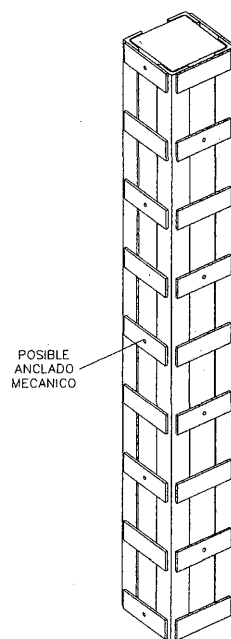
16. Refuerzo de pilar con perfiles metálicos.
